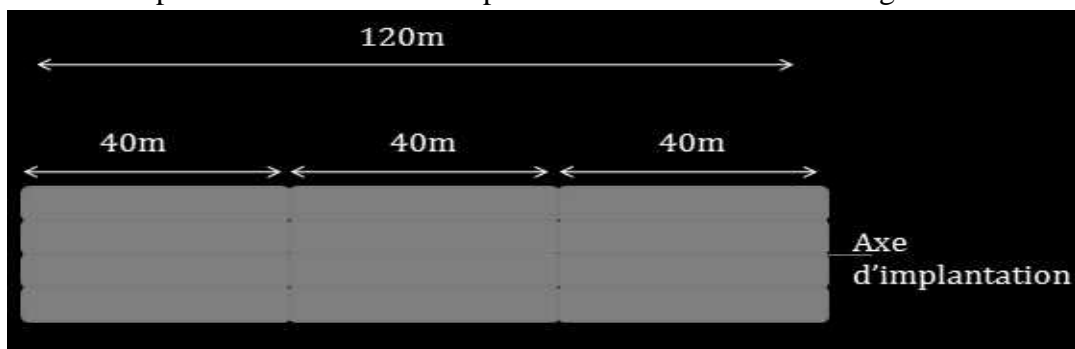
Plan horizontal de brise lames en géotubes proposés pour protéger la plage.
